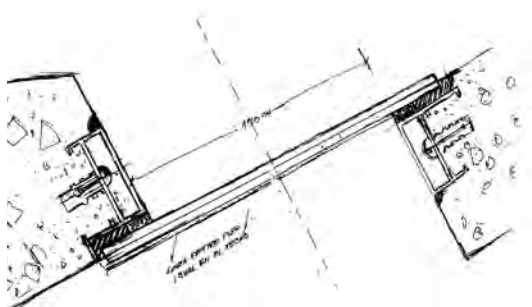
Detalle del desfazaje de los muros en las puertas pivot. Fuente: Daneri, 2016, p. 137.
